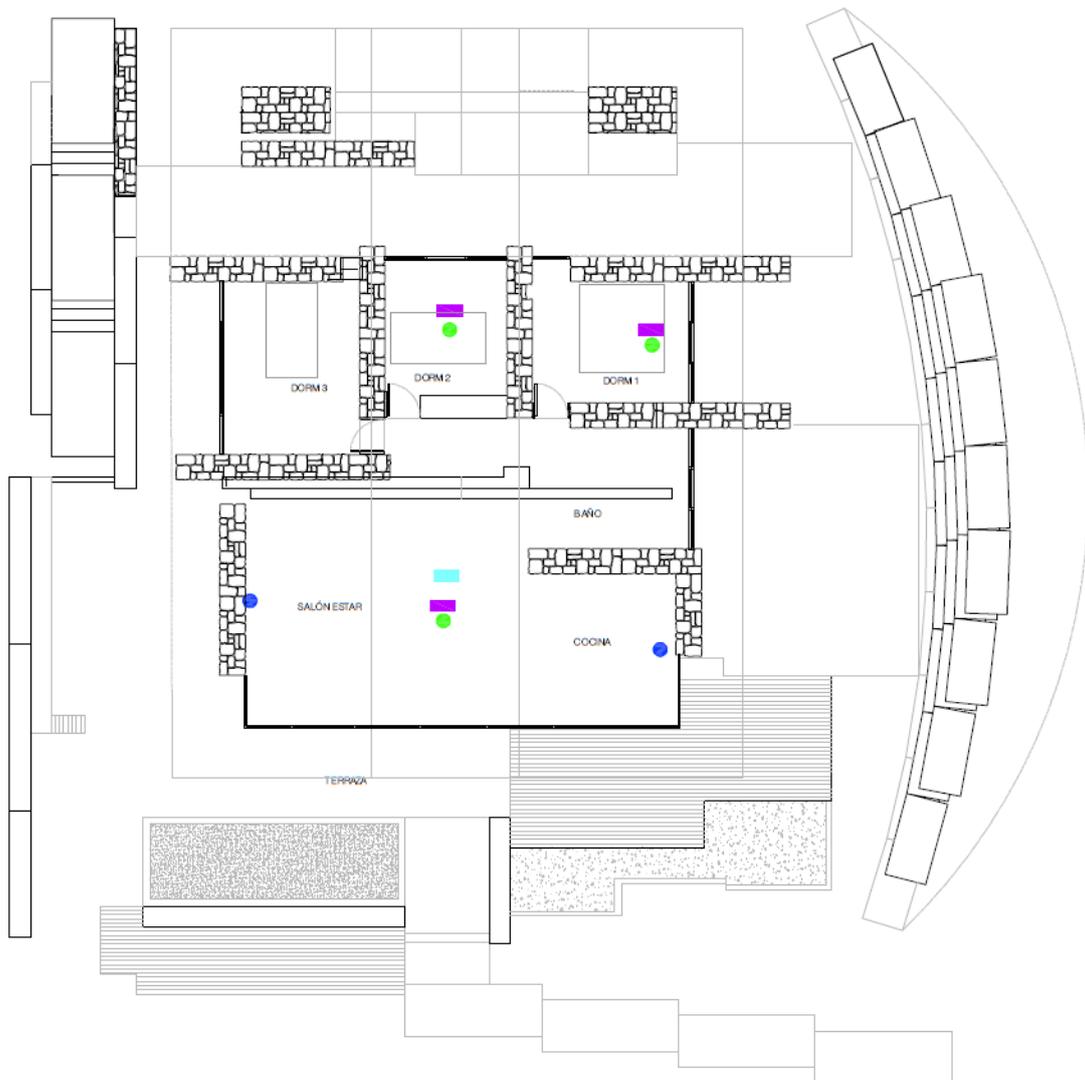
Localización de los sensores en planta baja de la vivienda 8 El Gavión
